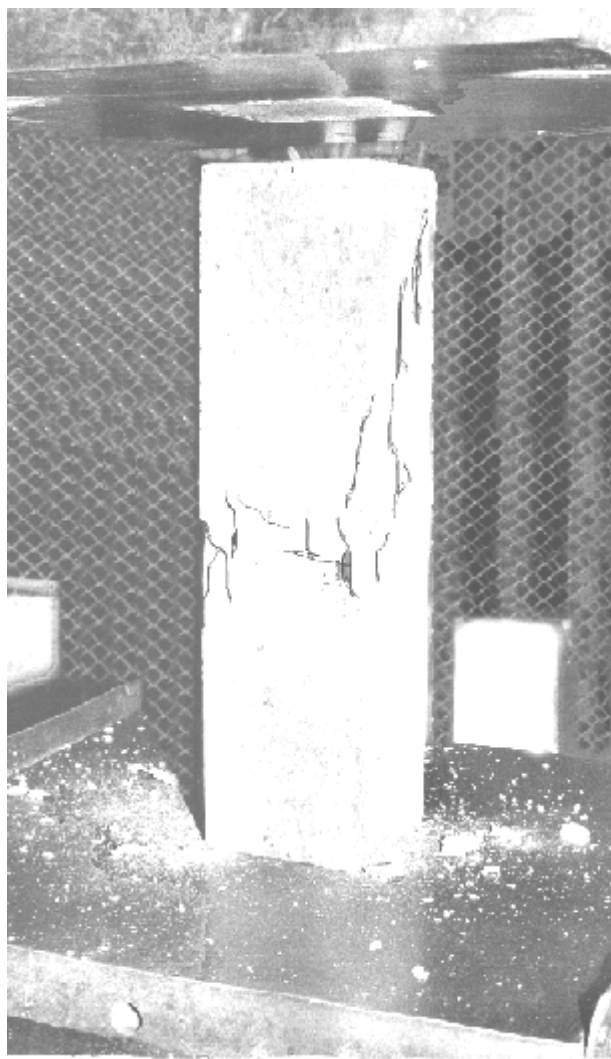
Фрагмент разрушения бетонной призмы
